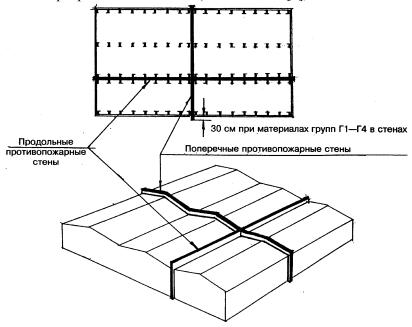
Разделение зданий на пожарные отсеки противопожарными стенами
